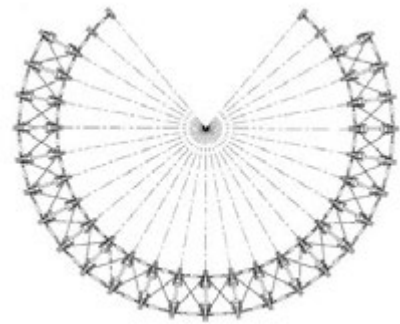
Padre Pio Pilgrimage Church, Architektura: Renzo Piano, konstrukcja: Ove Arup Engineers, [293].
